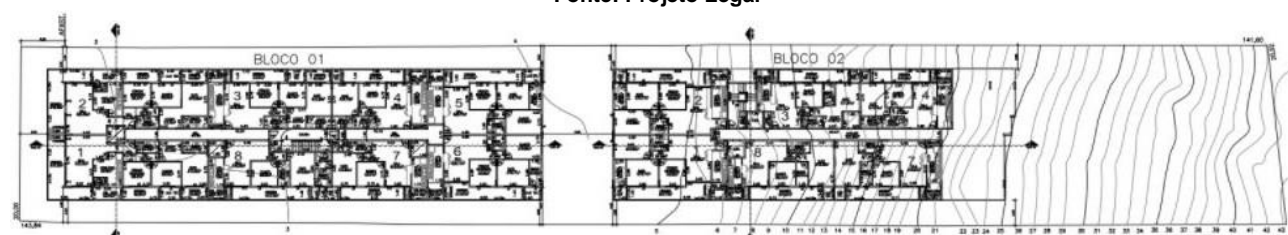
Pavimento Tipo (4º) – Blocos 01 e 02.
